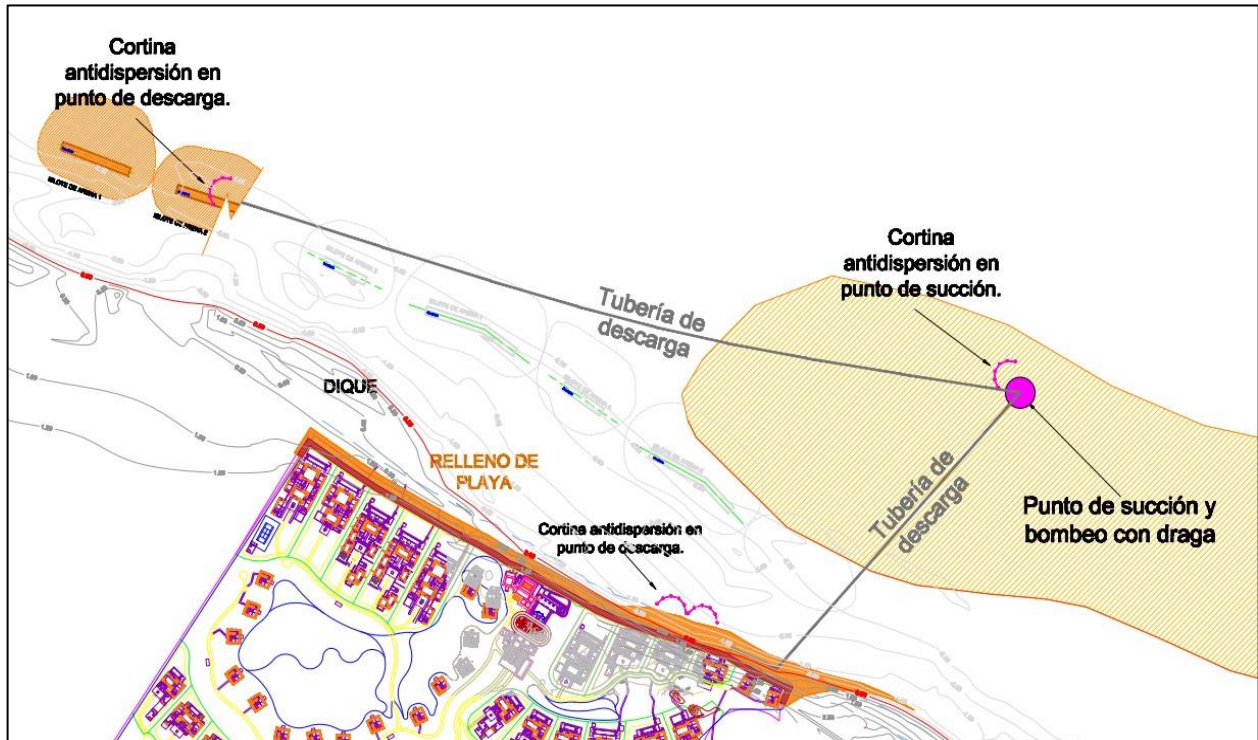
Ejemplo de la instalación de tubería flexible y de las cortinas anti-dispersión en zona AMAN/Mixta.
